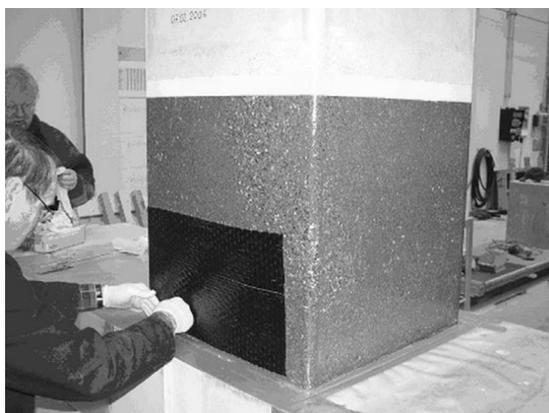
Внешнее армирование колонны с использованием метода влажной укладки композитного материала
